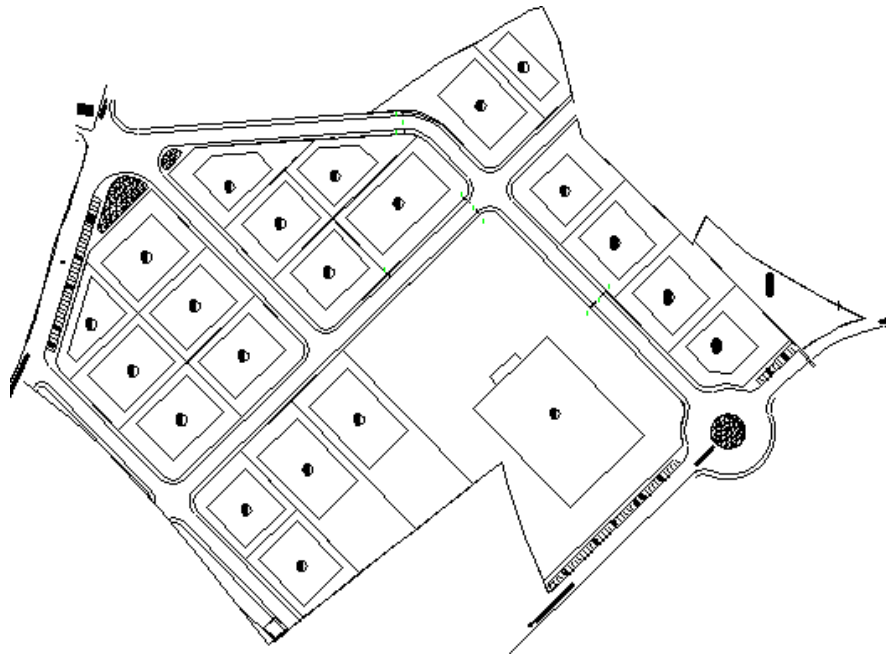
Planta do Loteamento Industrial em Carragedo de Montenegro
